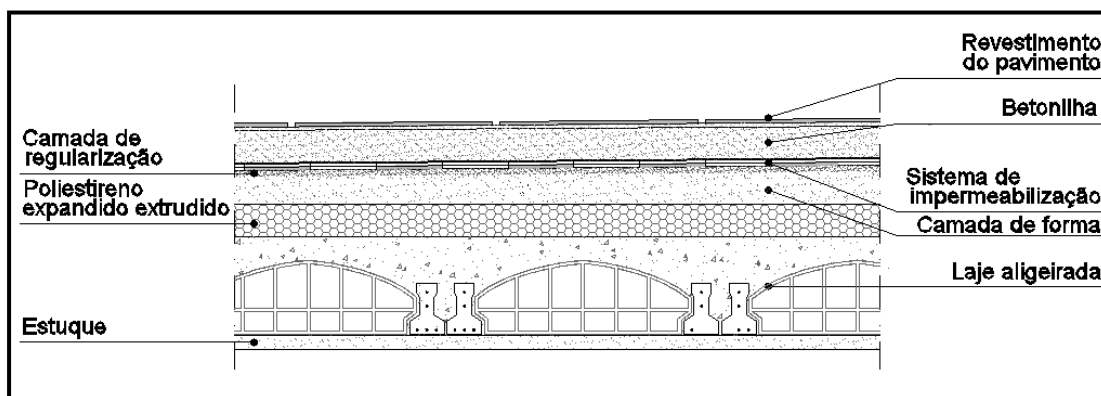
Pormenor da cobertura horizontal acessível em laje aligeirada, em corte (COB02)
